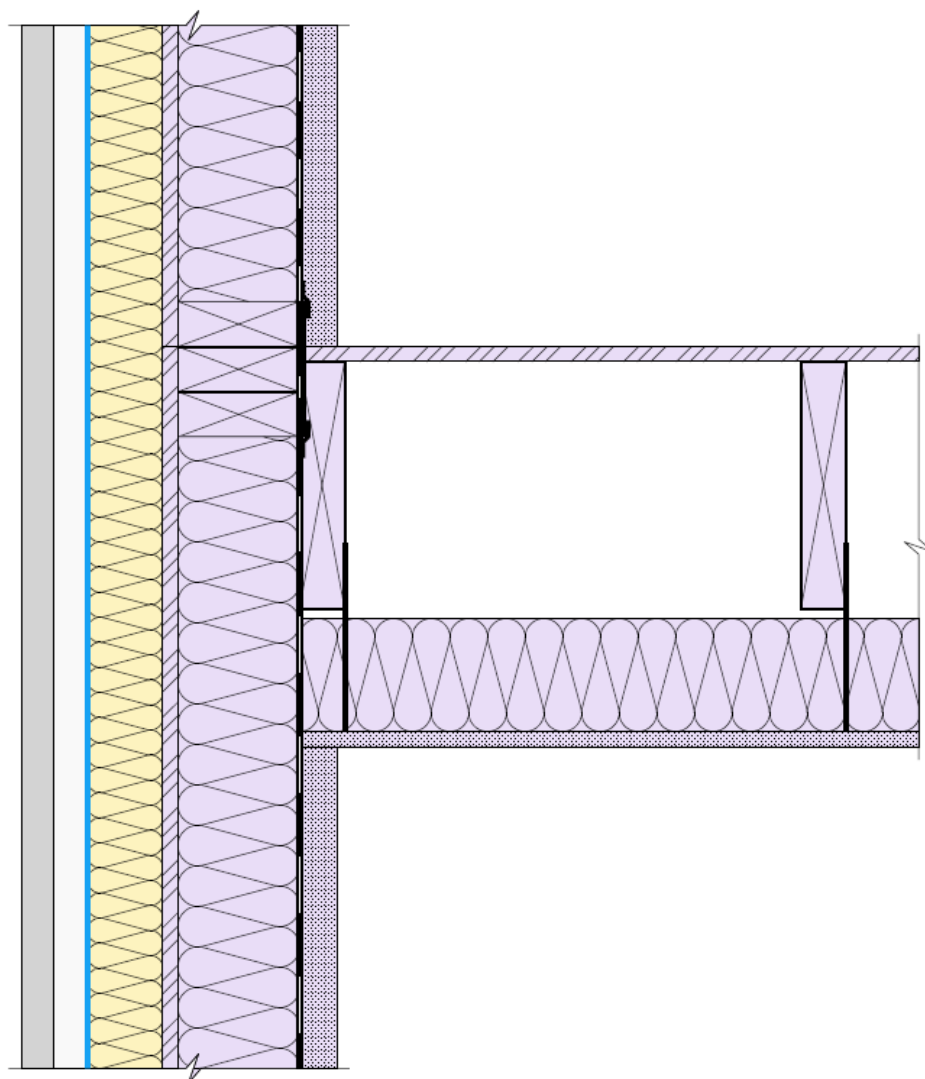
Plancher intermédiaire – sans fractionnement du bardage (coupe verticale)
